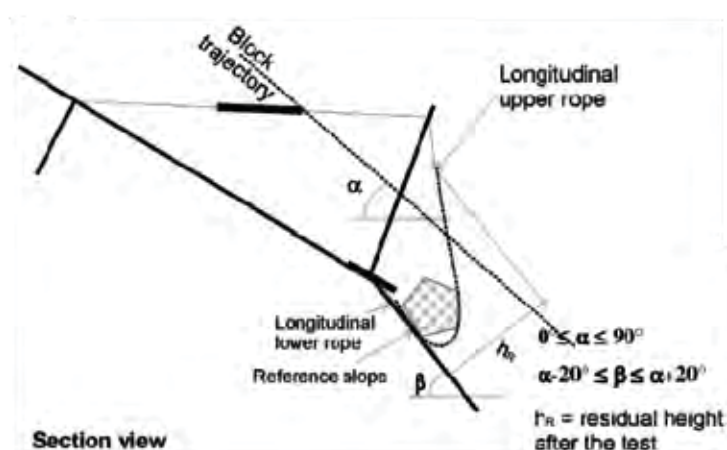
Le prove di crash-test previste dalle linee guida ETAG 027
